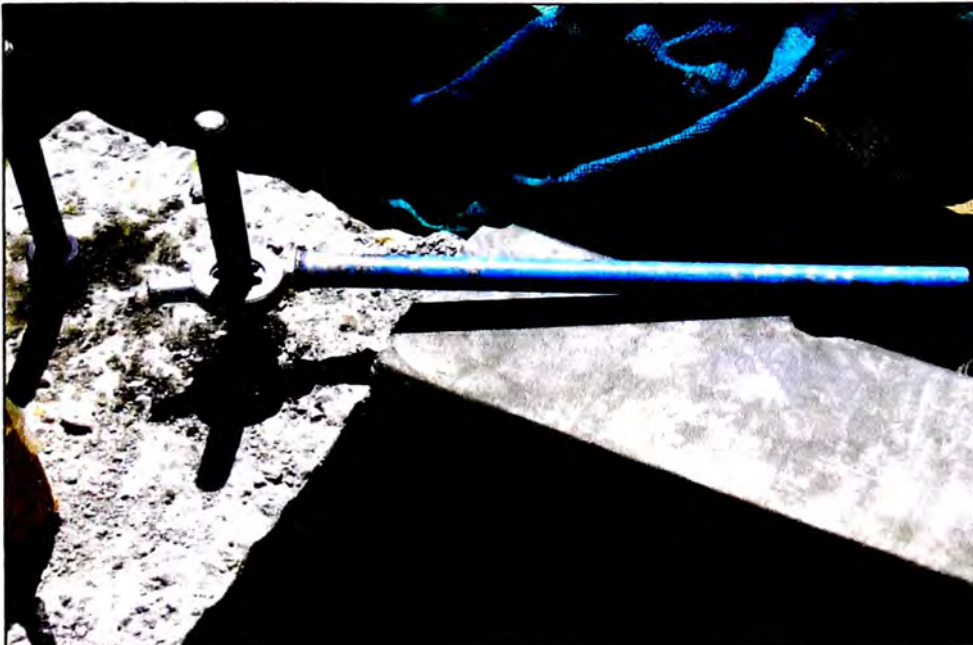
Modificación de silletas de anclaje de las columnas
